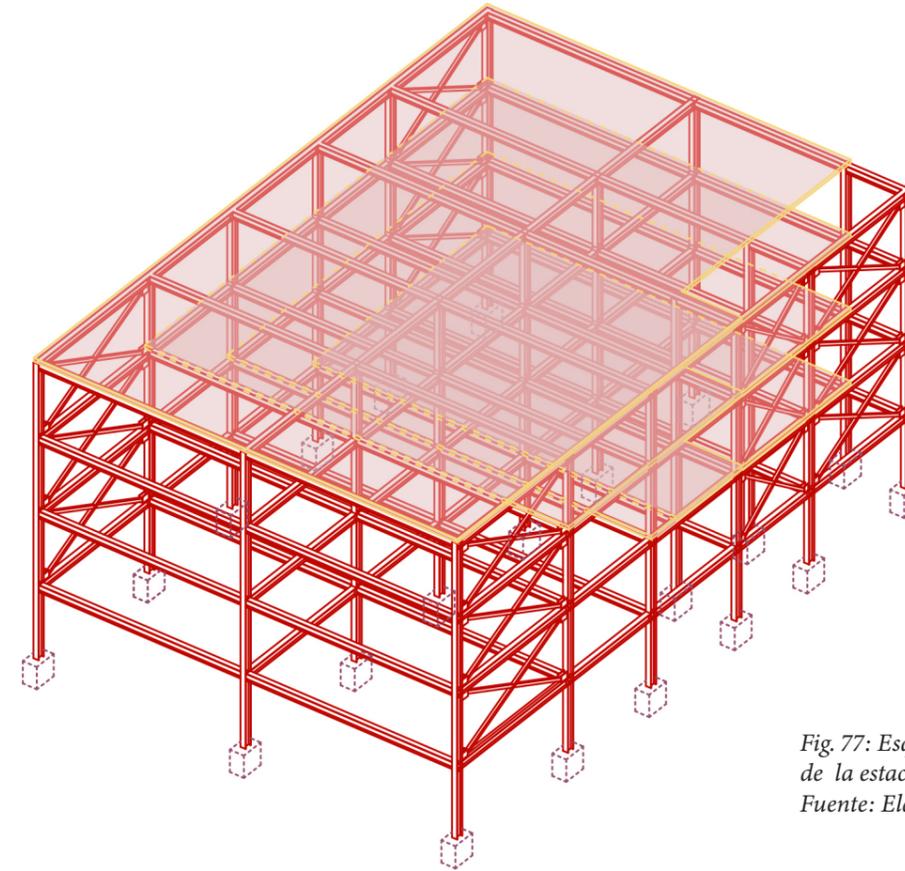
Esquema estructural de pórticos de acero de la estación Intermodal
